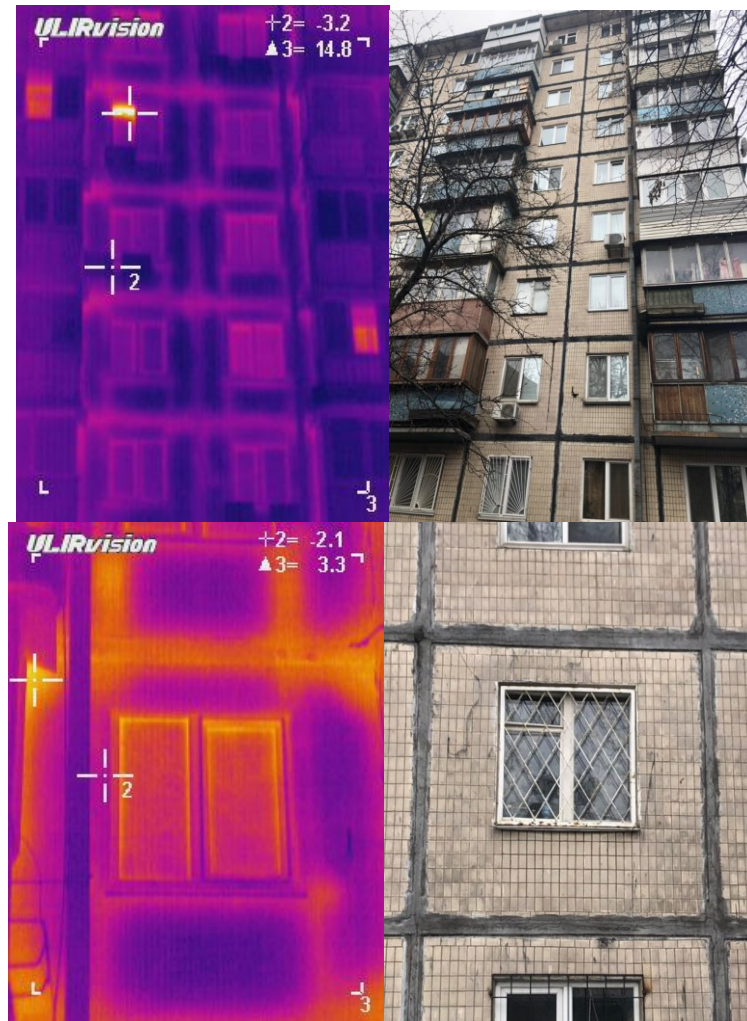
Тепловізійна зйомка фасаду будинку
